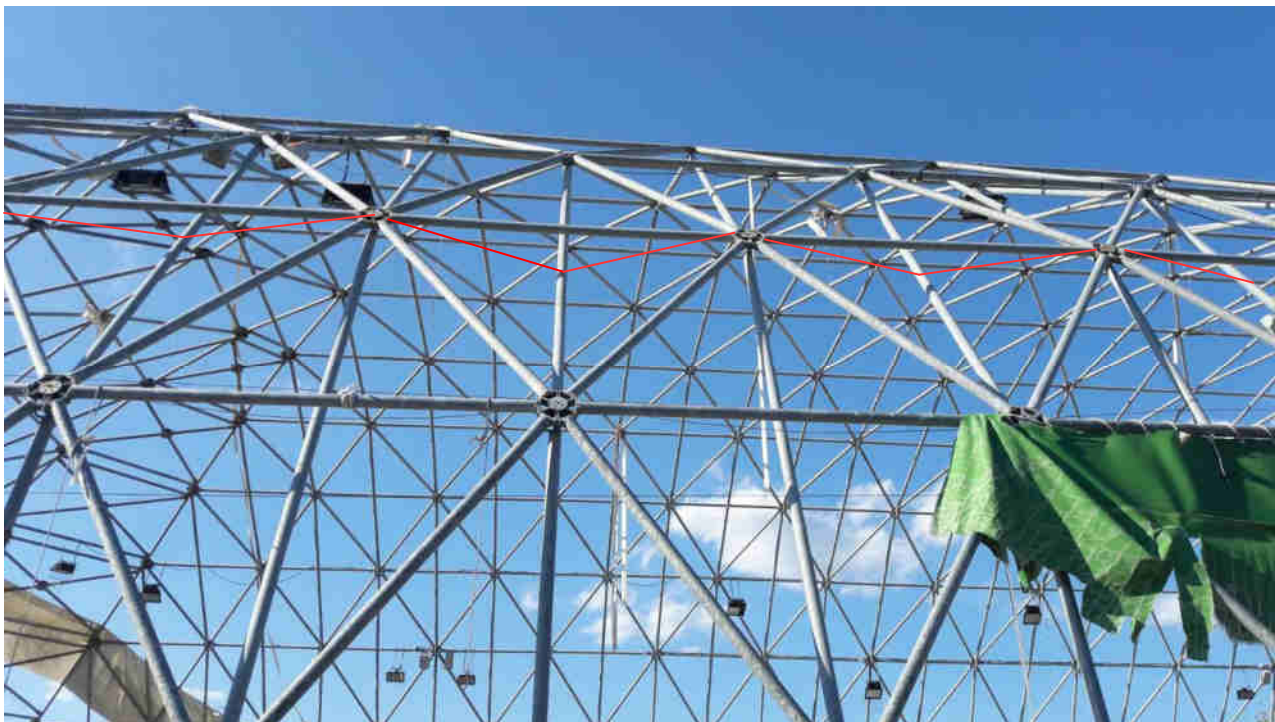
, vista della struttura. Si notino le linee rosse che indicano i rinforzi che risultano utili ad evitare l'instabilizzazione delle aste trasversali sotto l'azione del carico applicato (vento maggiorato). La relazione strutturale di calcolo esplicherà meglio il tema.
